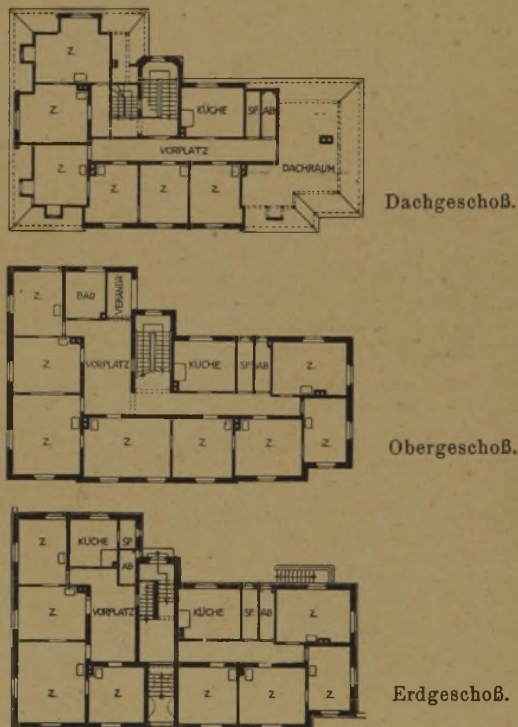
Lageplan. (1 : 2000.) Abb. 12—14. Grundrisse. (1 : 500.)
